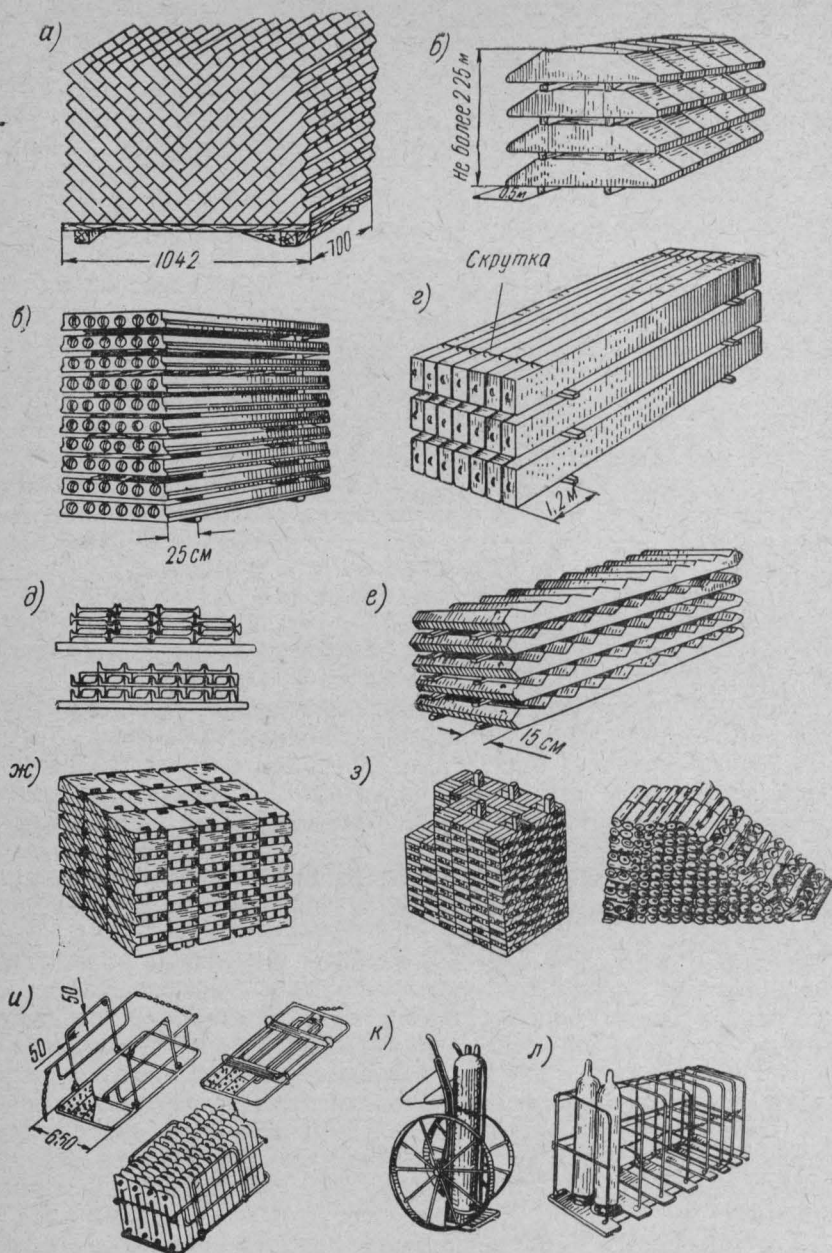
Укладка и складирование различных строительных деталей и материалов: а) пакет кирпича на поддонах с перевязкой «в елку»; б) фундаментные блоки; в) плиты перекрытий; г) ригели; д) балки и швеллеры; е) лестничные марши; ж) огнеупорные изделия; з) огнеупорные трубы; и) радиаторы в контейнере; к) тележка для перевозки баллонов; л) стеллаж для хранения баллонов с газами
